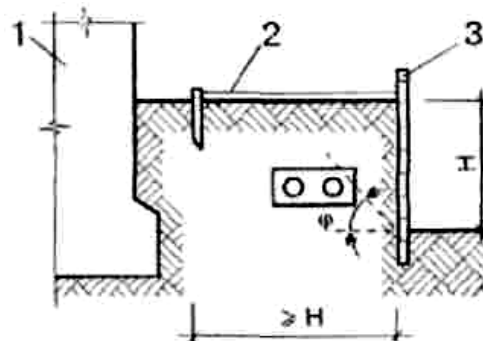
Схема анкерного кріплення (Н – глибина виїмки): 1 – існуюча конструкція; 2 – анкерна тяга; 3 – захисна конструкція; 4 – комунікації
